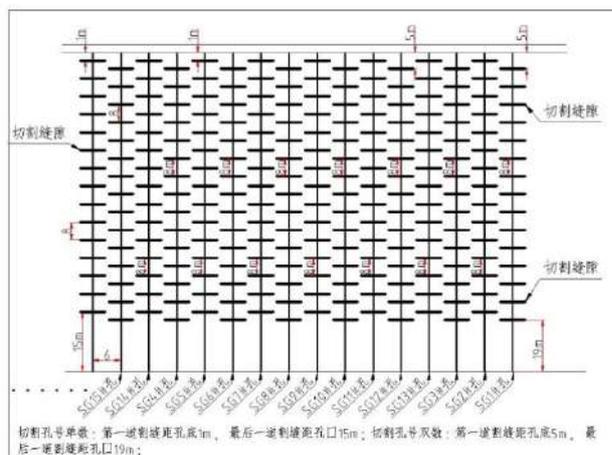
高压水射流增透卸压瓦斯抽放孔平面图
